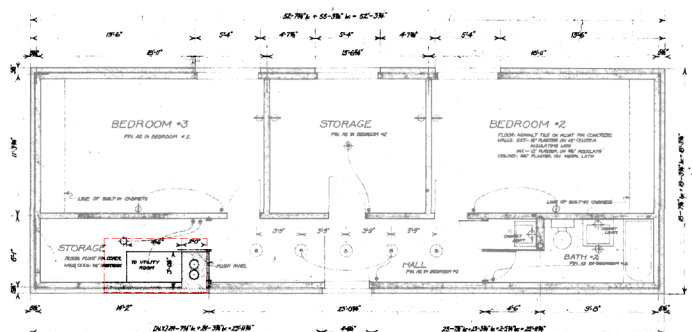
Planta da Brick House (escala 1:200) à esquerda. Indicação de um espaço para instalações - "Utility Room" - à direita (escala 1:50).
